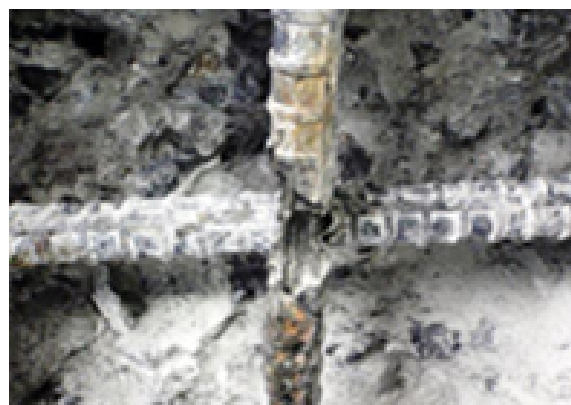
ひび割れ箇所の鉄筋腐食状況
